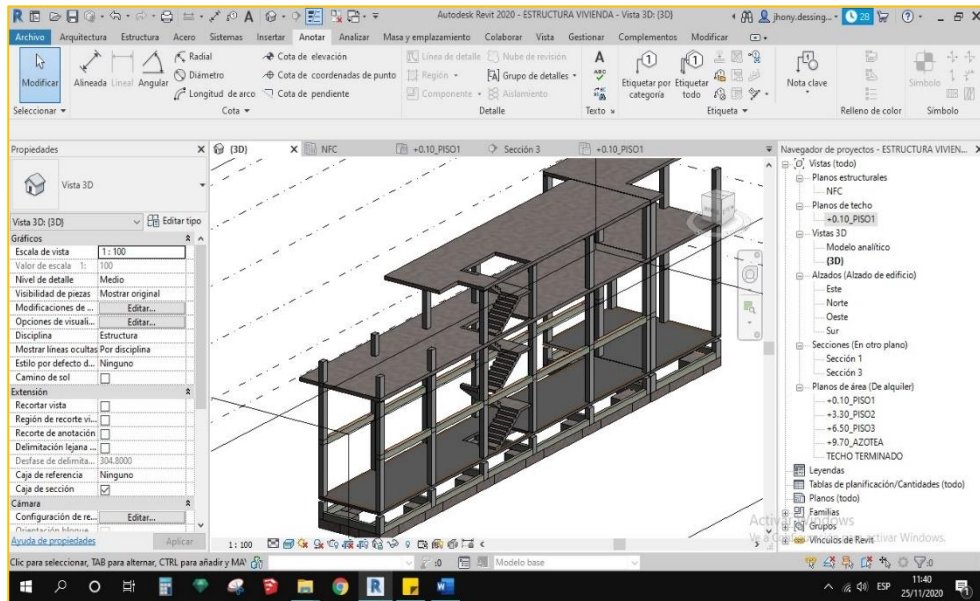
Vista isométrica 3D de vigas tipo VA-2 (0.25 x 0.35 m).
